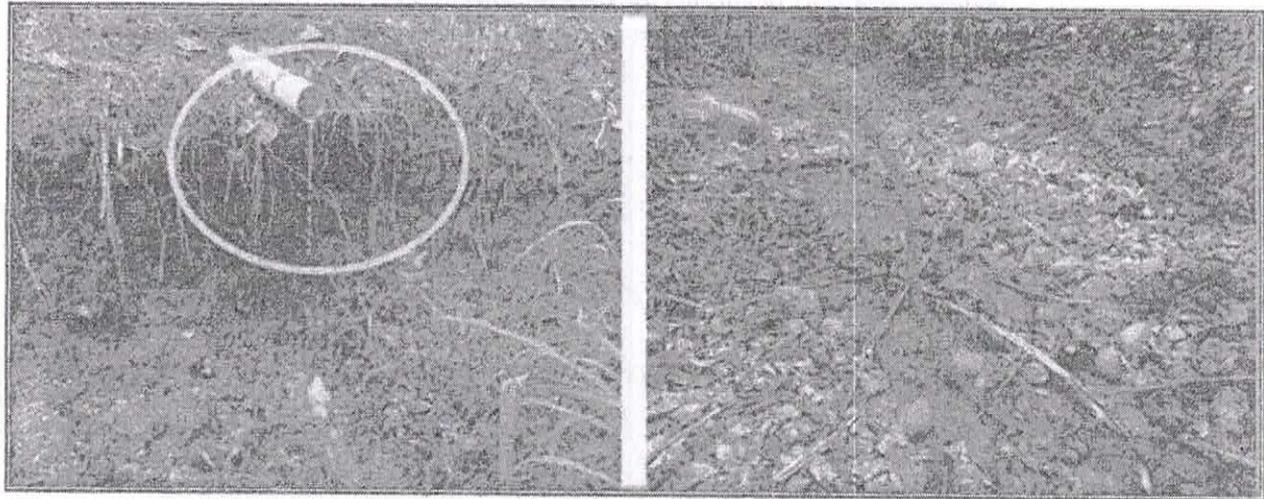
y 9: Sistema séptico instalado en el predio San José
